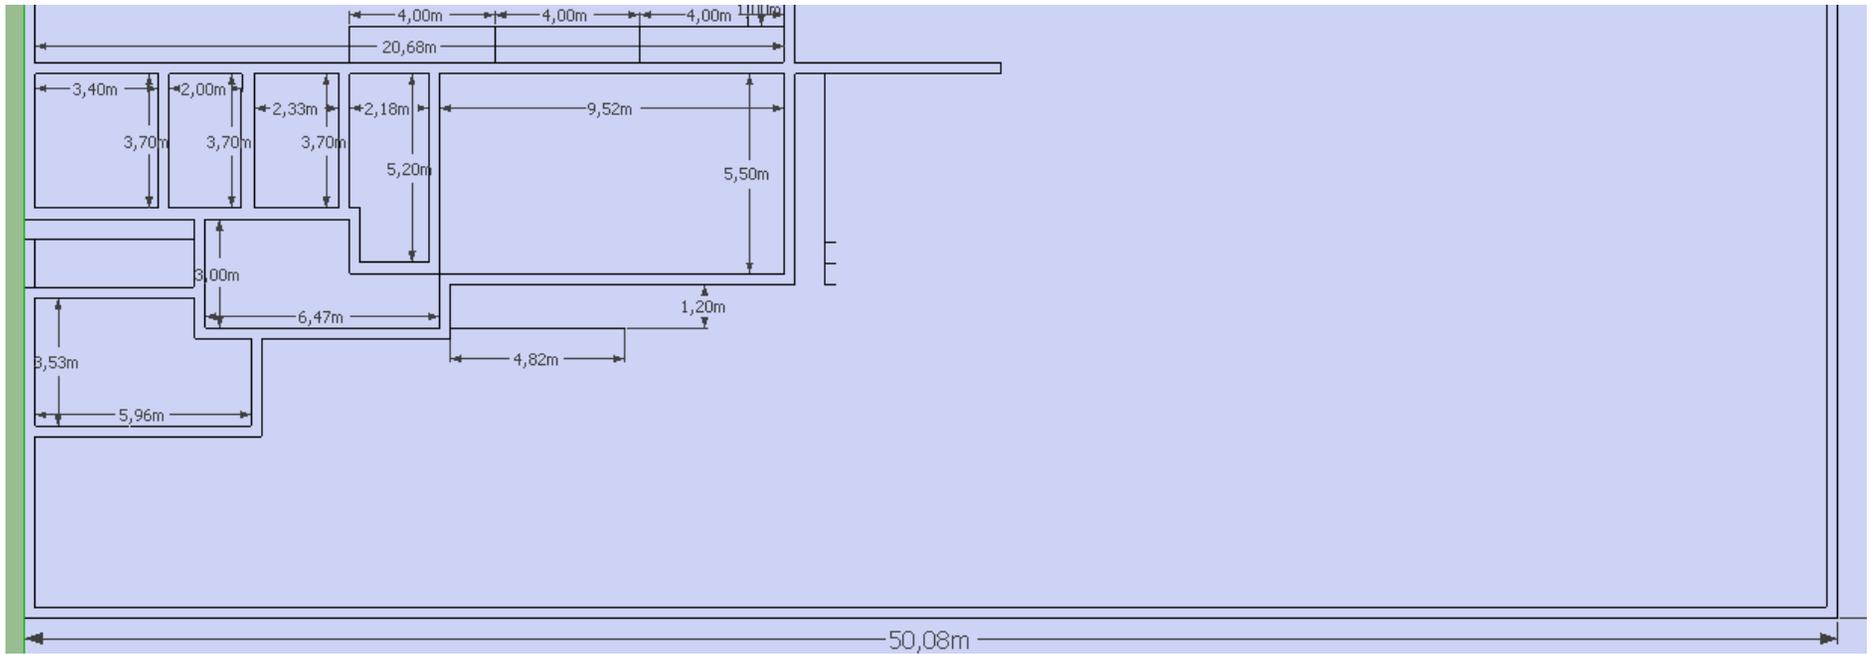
Vista planta del área de oficinas y estacionamiento de empleados y visitantes
